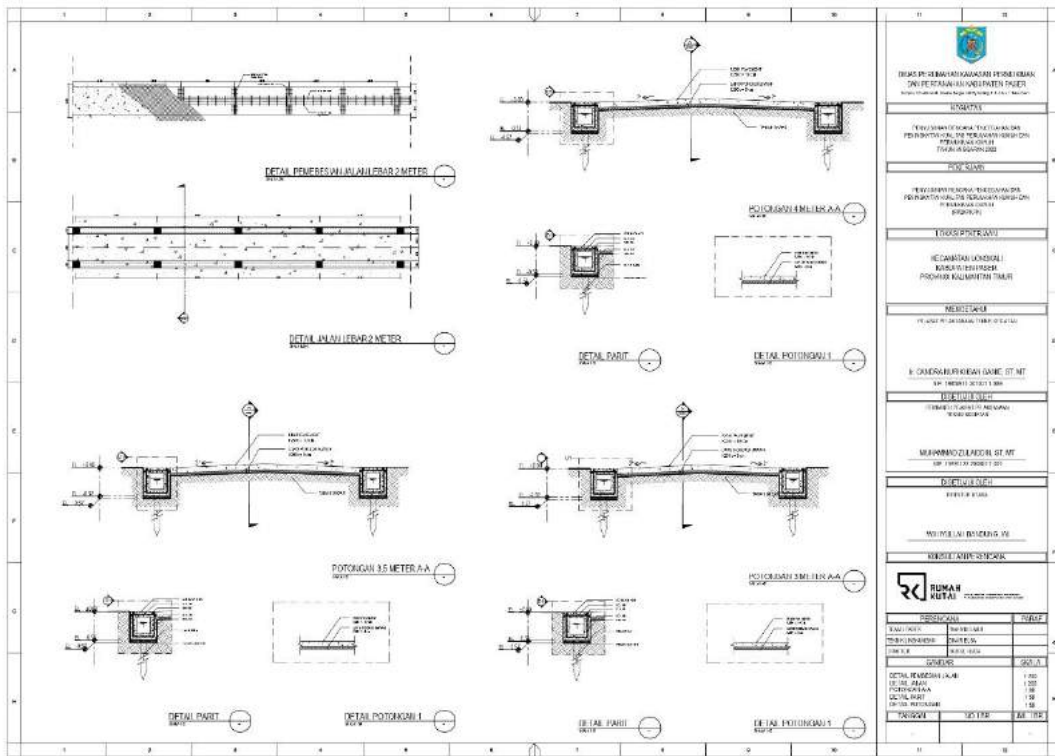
113 Konsep Rencana Jalan Segmen 8 RT.16
